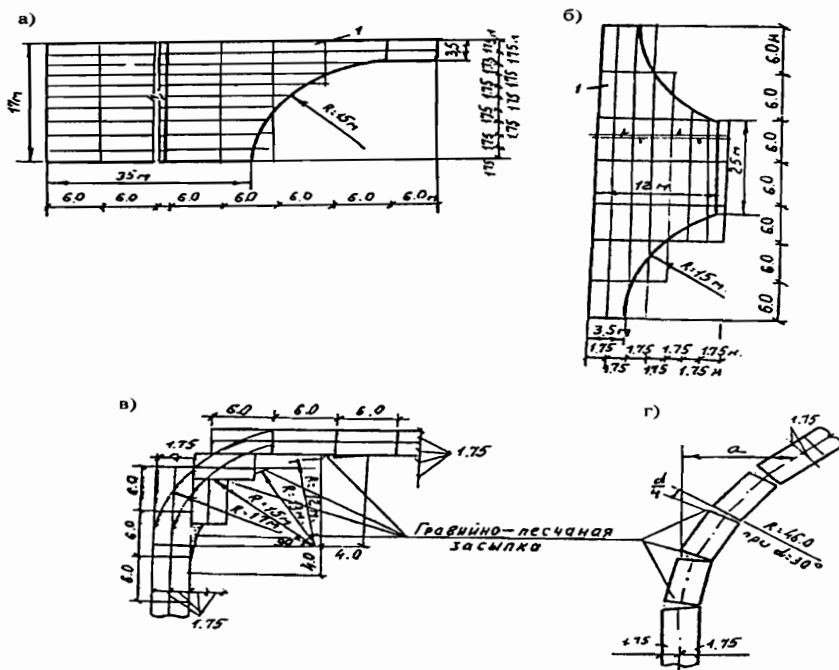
Временные дороги для автомобильного транспорта из сборных железобетонных плит: а - тупиковая дорога с разворотной площадкой; б - уширение дороги для стоянки автотранспорта; в, г - схемы поворотов из плит 6,0×1,75 м и 3,0×1,75 м
